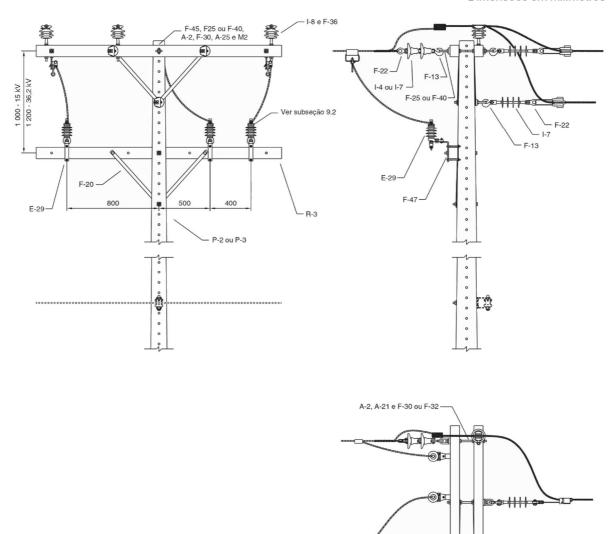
Estrutura CE3.N3 PR - Poste de concreto de seção DT ou de madeira
